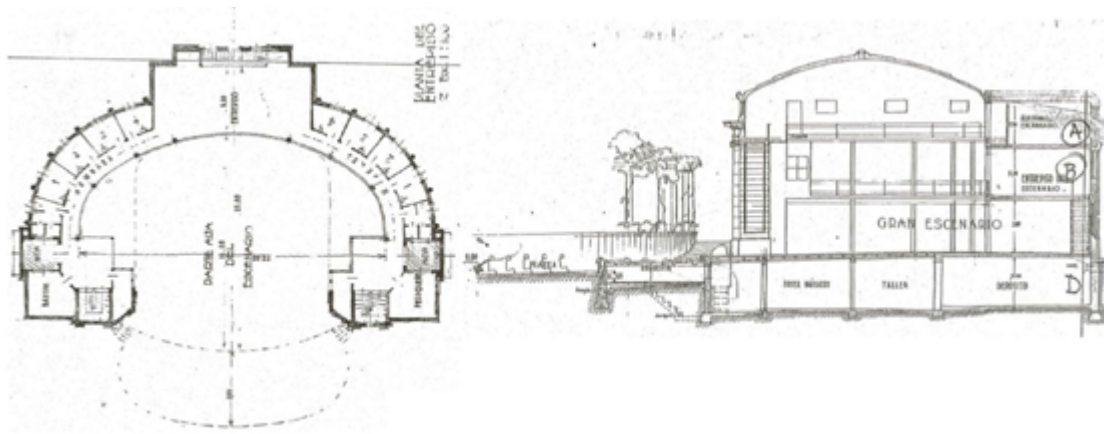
Planta y corte del edificio, planos históricos. Fuente: Ucalp.
